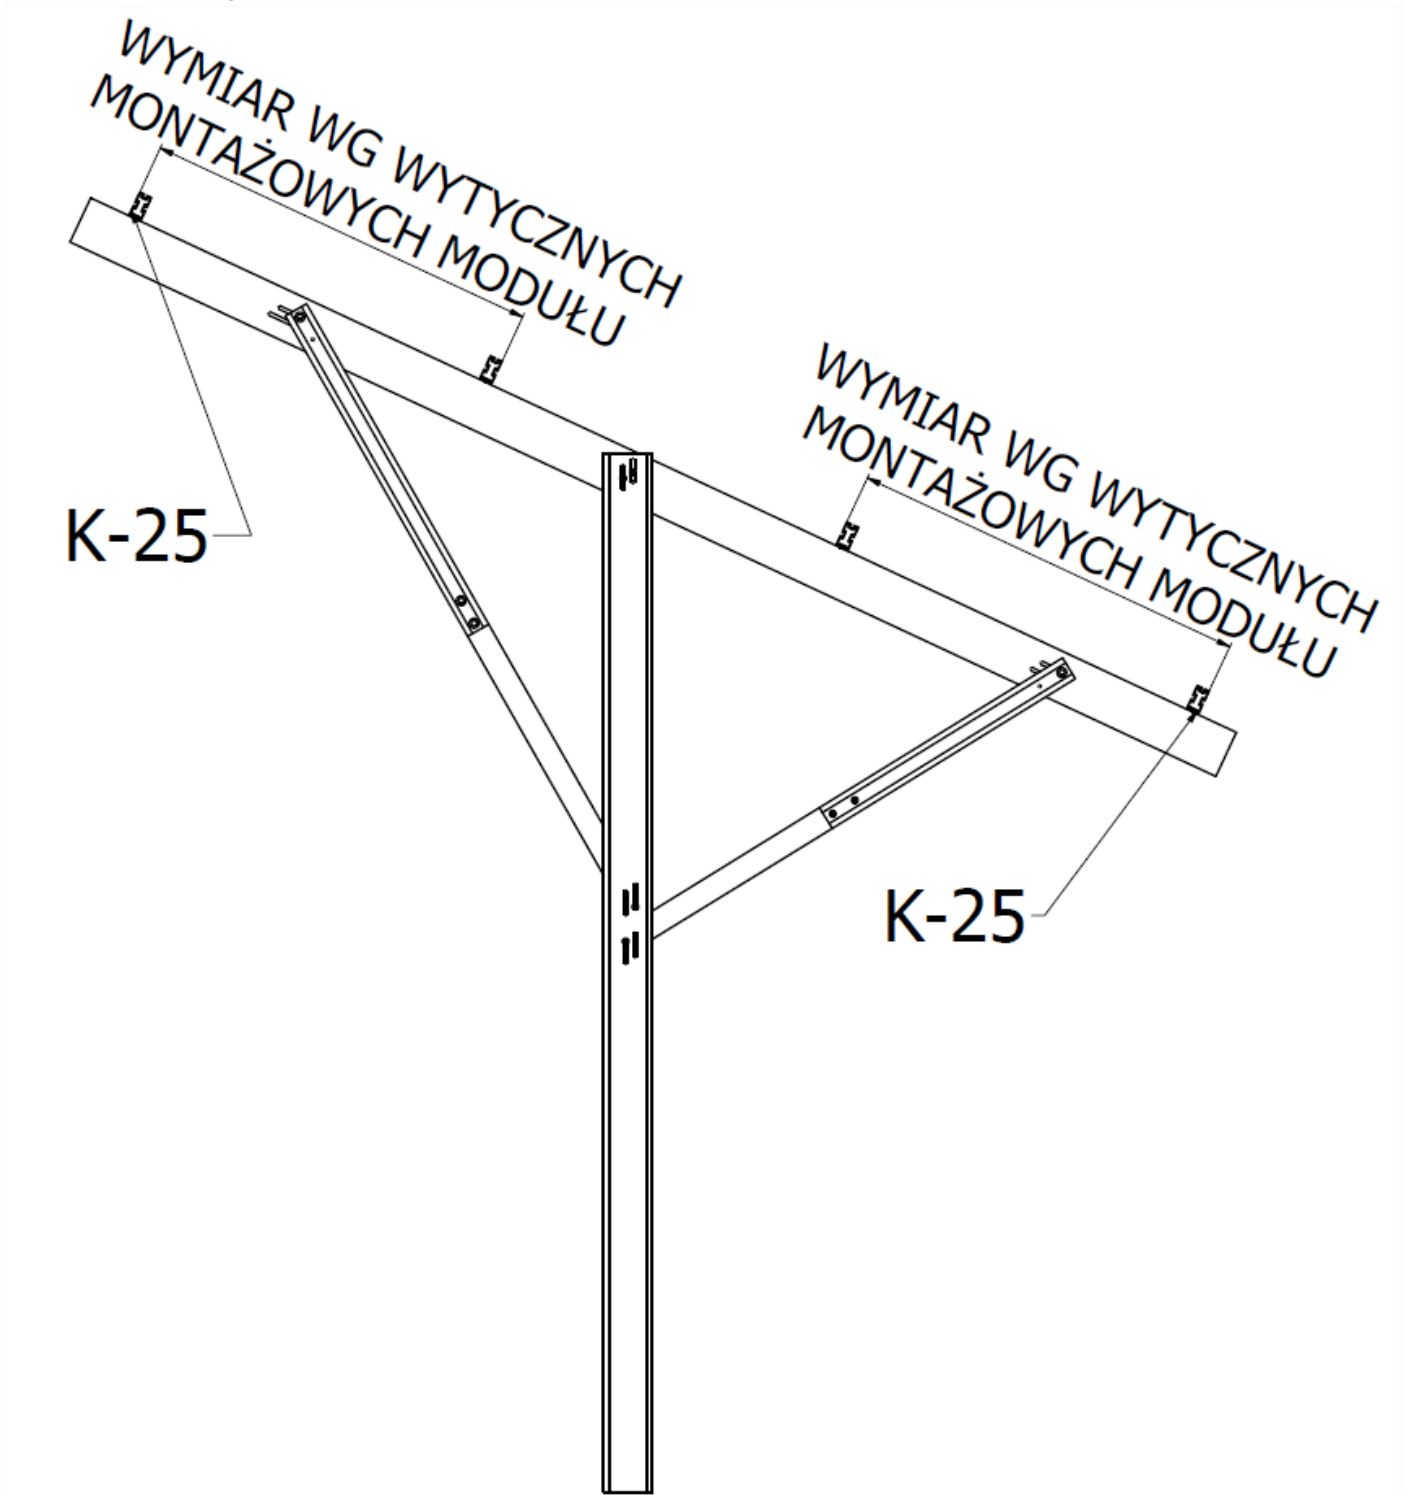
Montaż profilu K-25 do krokwi K-22-XL-15
